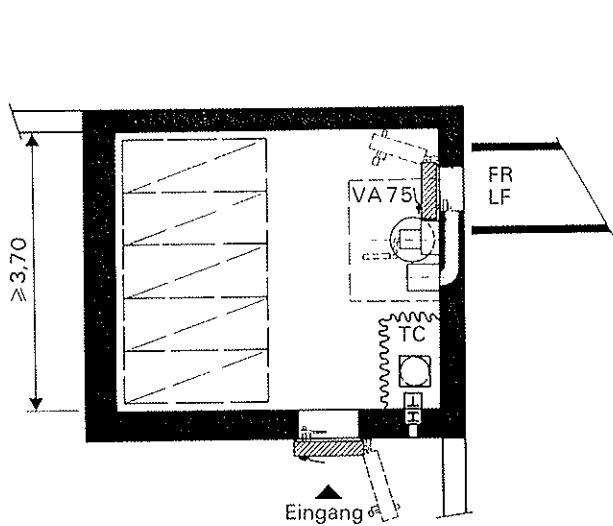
Grundrissform für 12 Schutzplätze (Bodenfläche $\geq 13 \text{ m}^2$)
